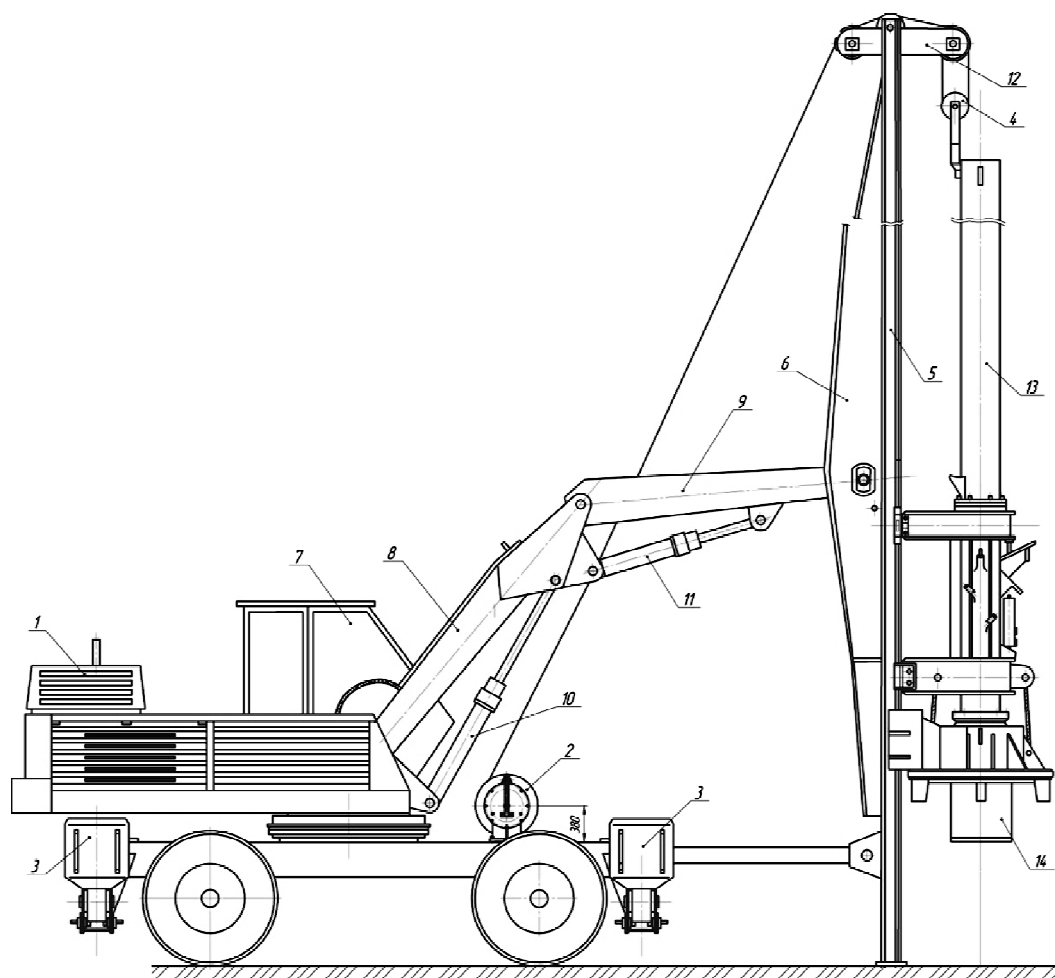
Оборудование для погружения свай и забивных блоков на базе экскаватора ЭО-3322: 1- базовая машина; 2 – лебедка для подъема дизель-молота и наголовника; 3 – выносные опоры; 4- полиспаст; 5- направляющие; 6- копровая мачта; 7 – кабина; 8,9- нижняя и верхняя части стрелы; 10- гидроцилиндры подъема стрелы; 11- гидроцилиндры наклона стрелы; 12- траверса; 13- дизель-молот; 14- наголовник.
